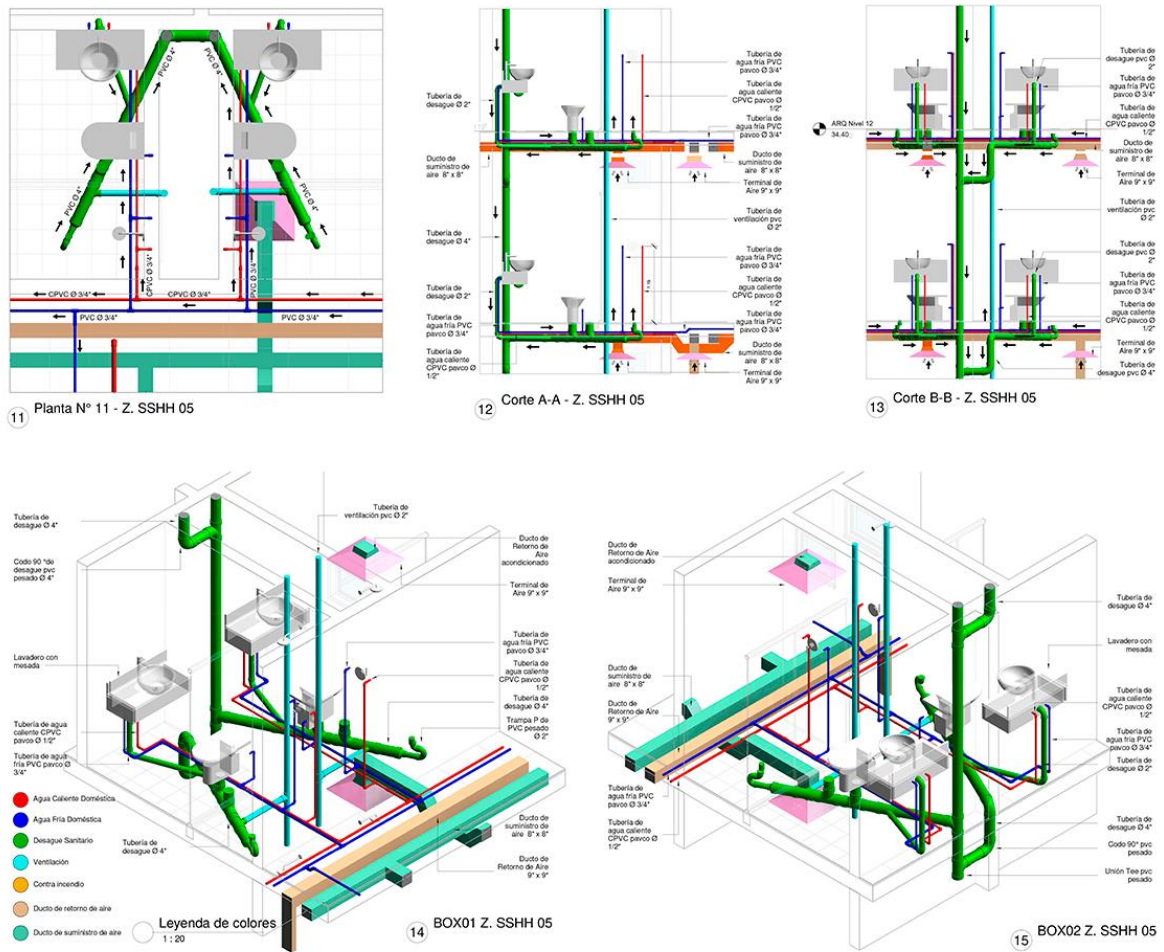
Traçado de instalações técnicas em instalações sanitárias<sup>14</sup>
